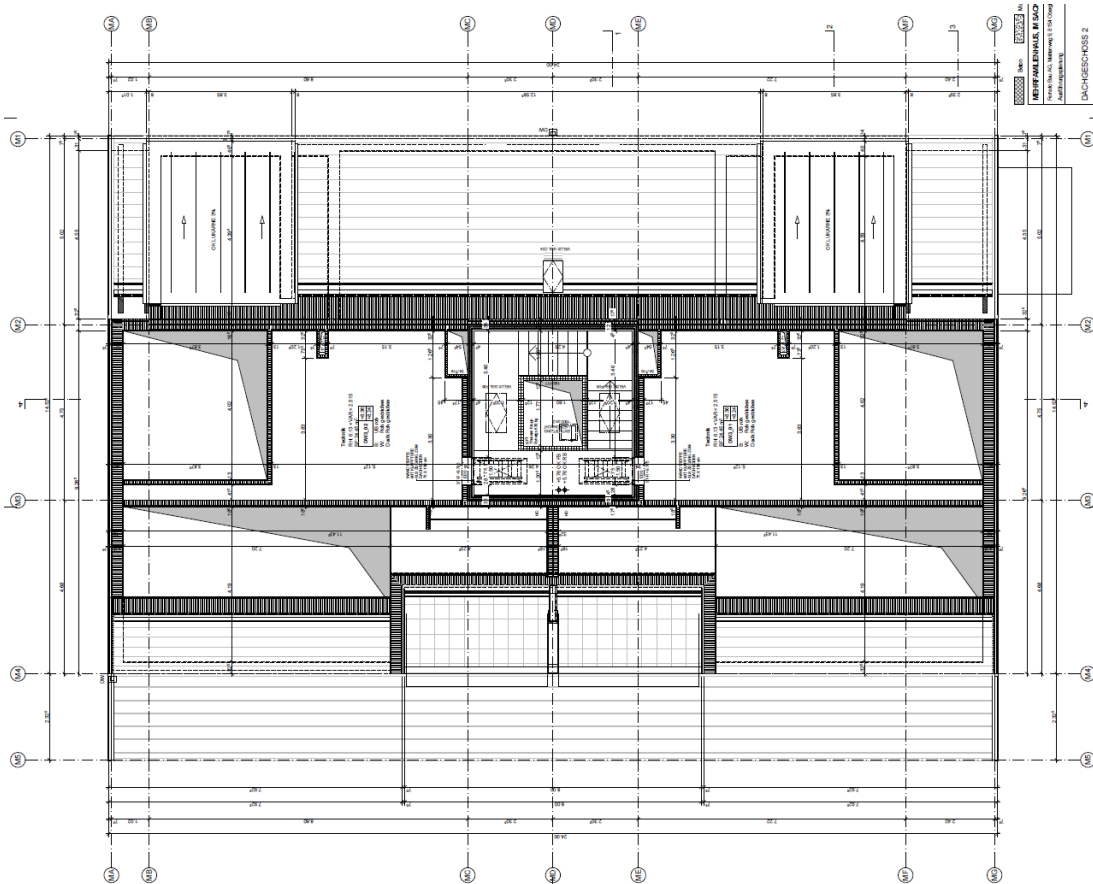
Grundriss Dachgeschoss 2 (Bild ZBF Architekten AG)
